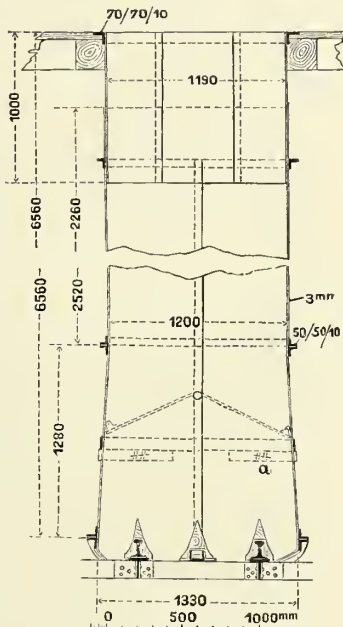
Wagen zum Versenken von Beton zur Unterbettung der Hellinggleise.
